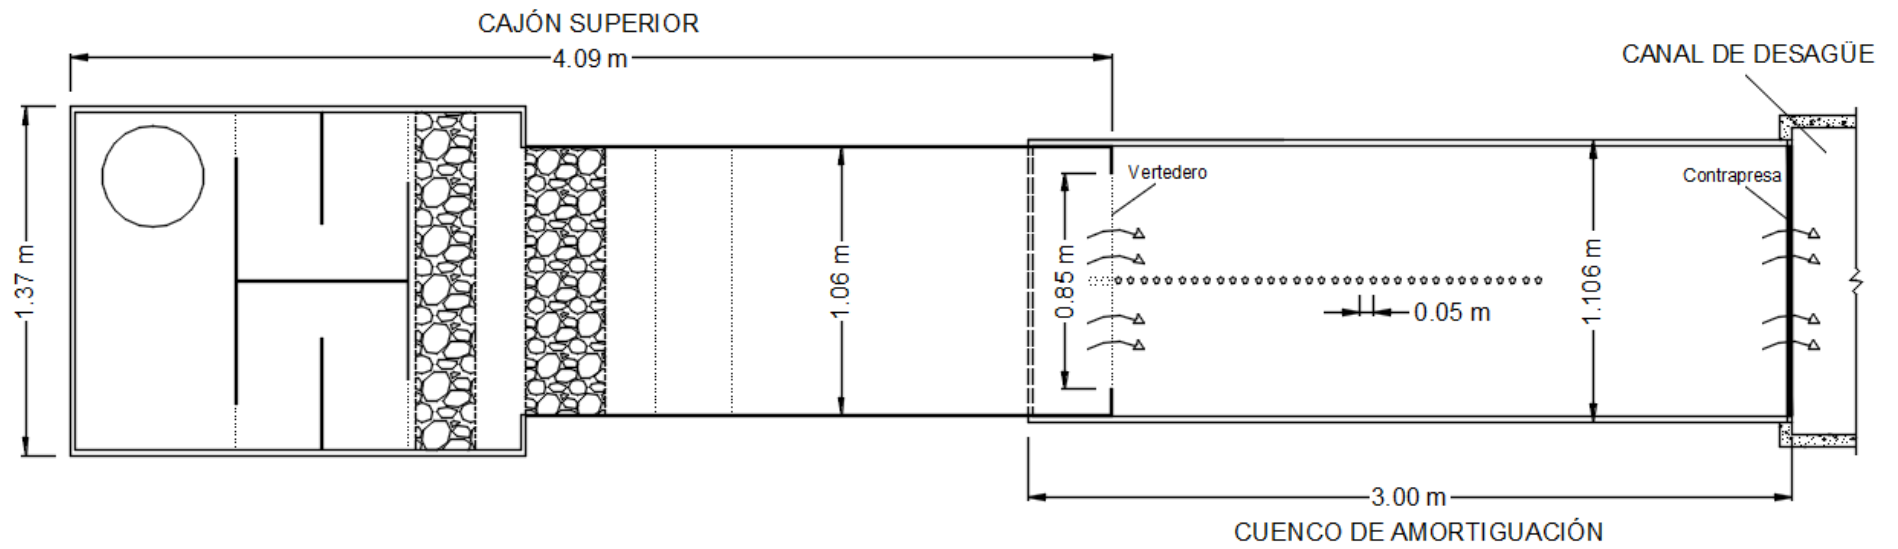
Planta del Cajón superior, cuenco de amortiguación y canal de desagüe de la infraestructura del laboratorio realizada con AutoCAD.
